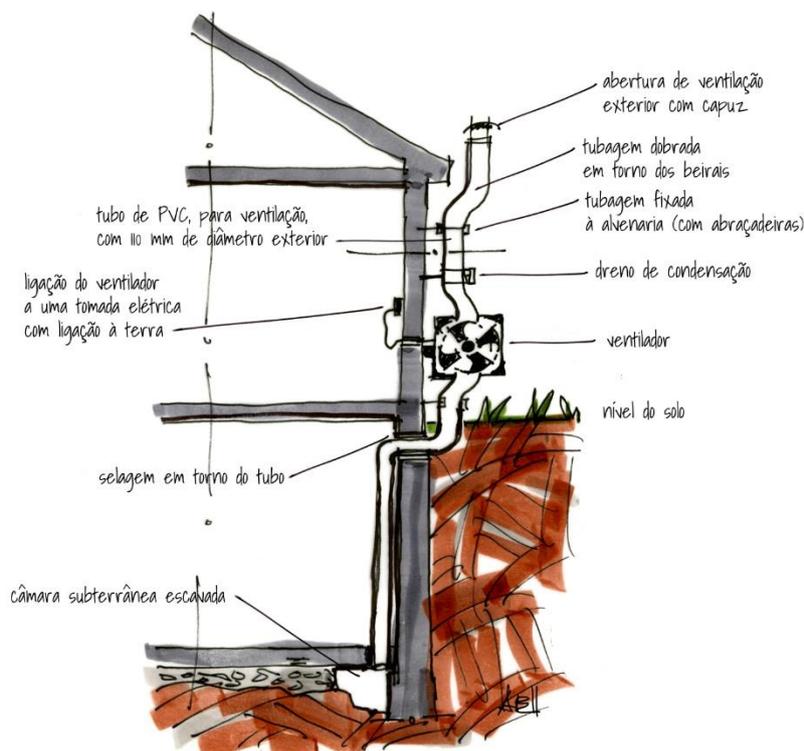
Exemplo de sistema de depressurização do terreno debaixo da laje térrea de uma cave, com condutas e ventilador localizados no exterior
